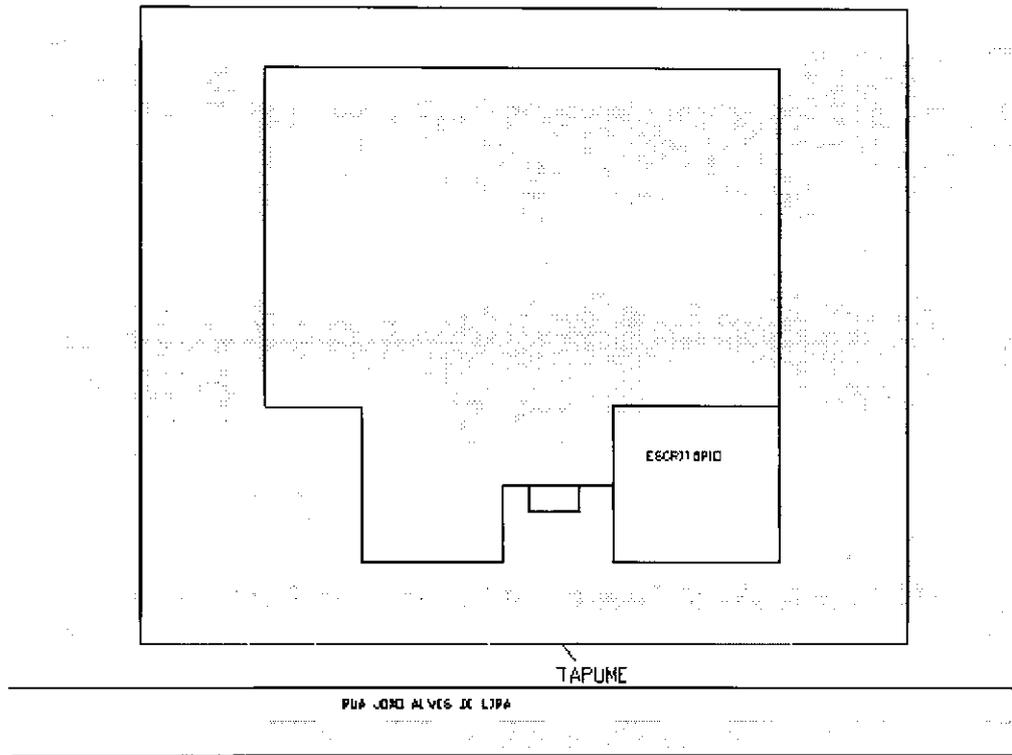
Esboço do canteiro de obras - 2ª Laje
